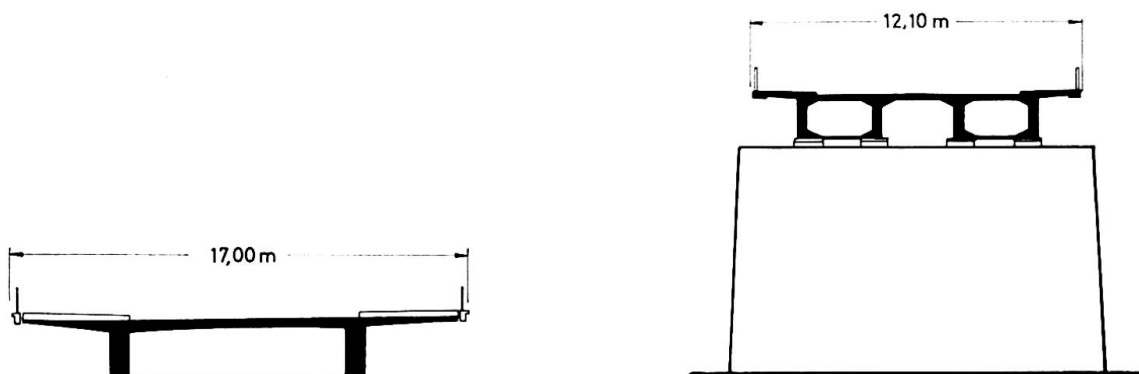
Typische deutsche Querschnitte von Brücken mit Plattenbalken und Hohlkasten.
